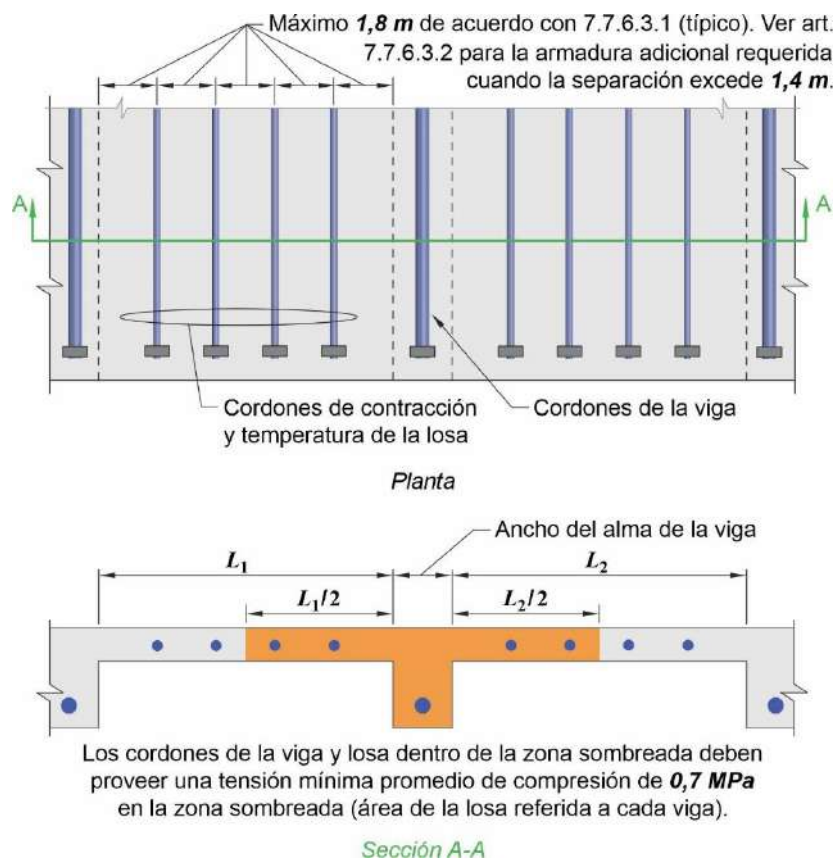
Sección a través de vigas construidas monóticamente con la losa
